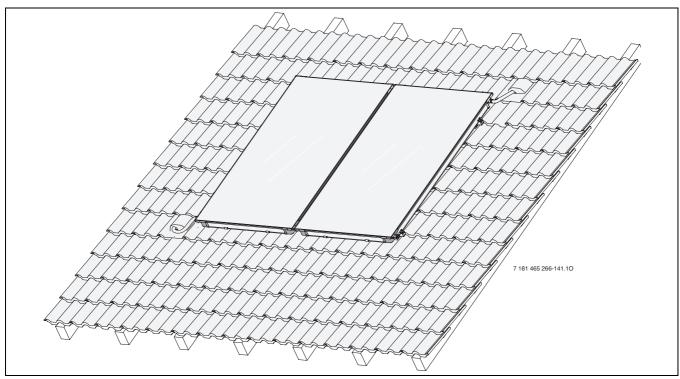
Aufdachmontage mit zwei Flachkollektoren FKC-1S
